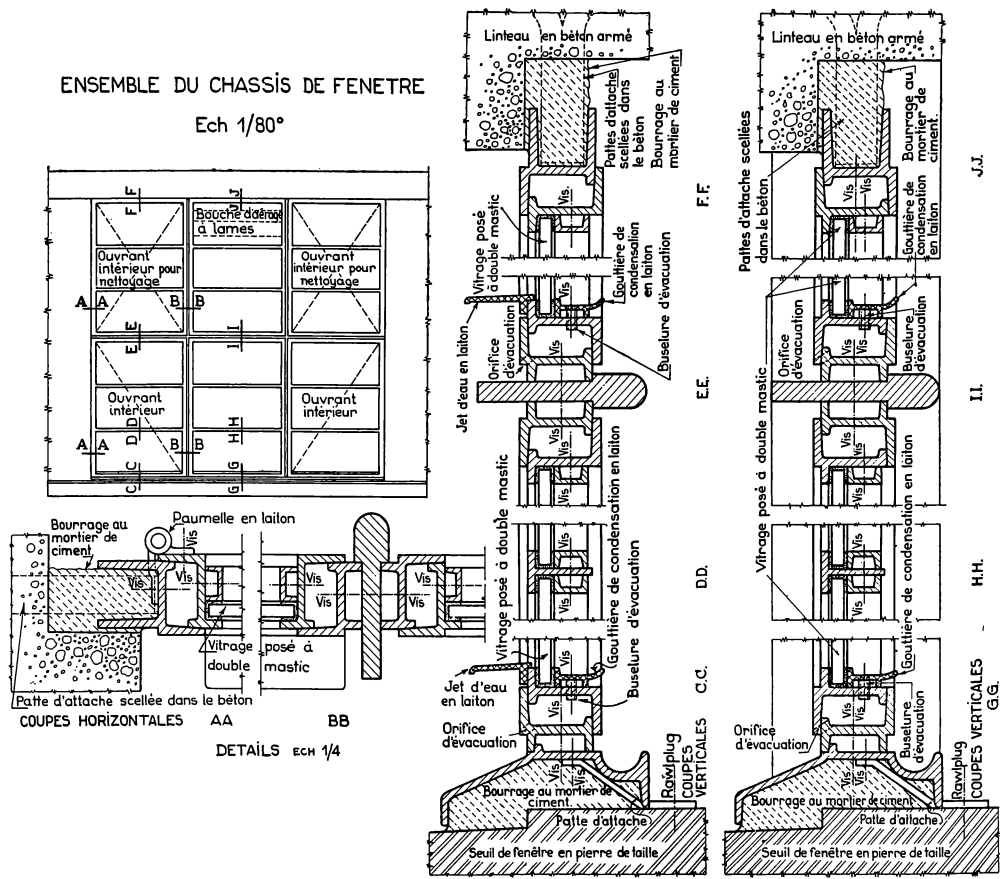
Ensemble et détails d'un châssis métallique type.
